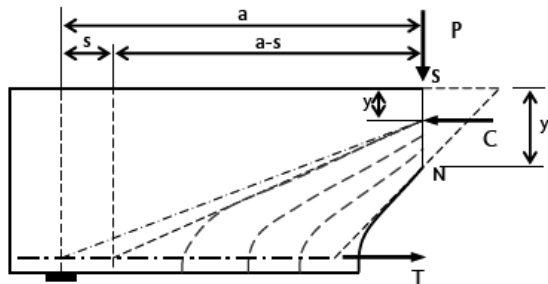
d. Condición de equilibrio en la viga previa al colapso por cortante (P. Padilla)
